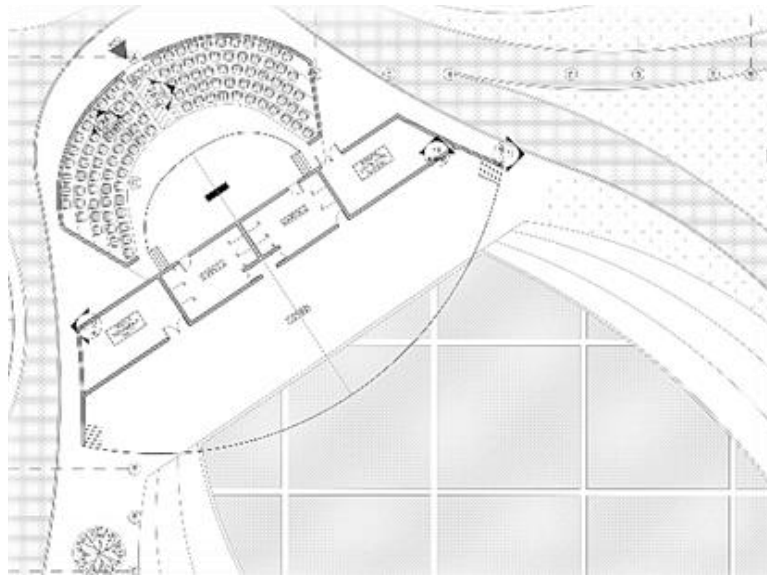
Planta primer piso zona cultural concha acústica y auditorio. Elaboración propia.
